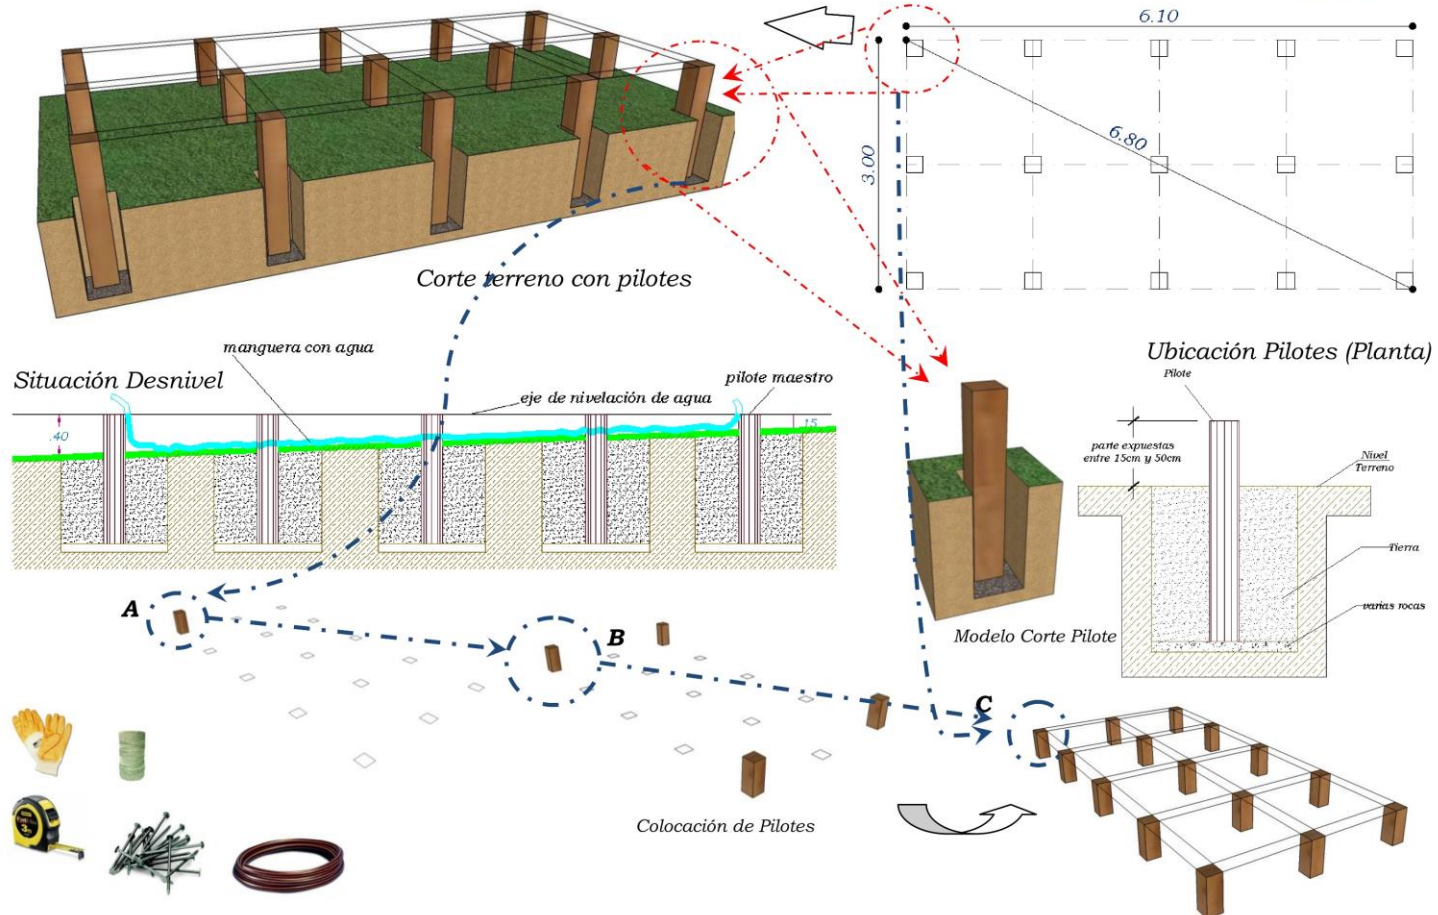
Colocación de pilotes, Fuente: Manual para la construcción - TECHO
